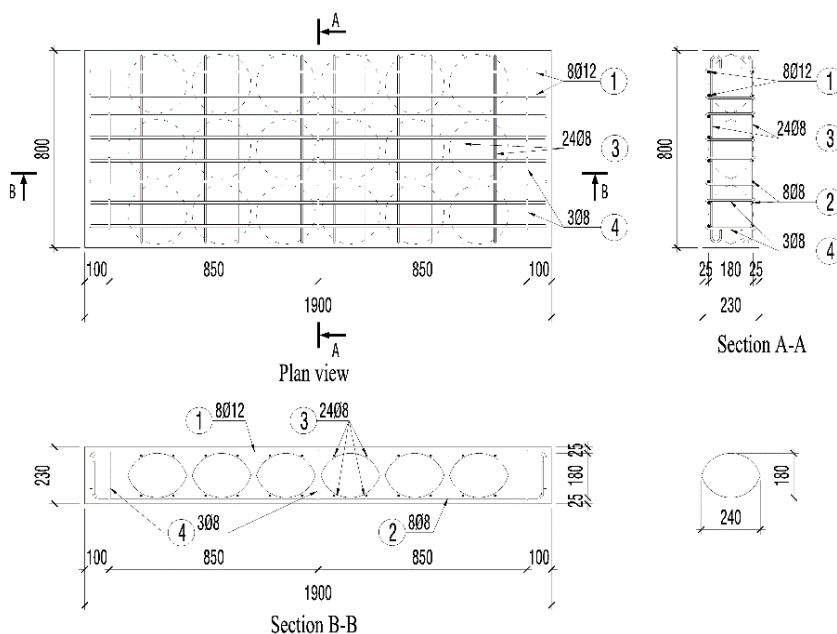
Características das lajes ensaiadas por Hai *et al.* (2013).
